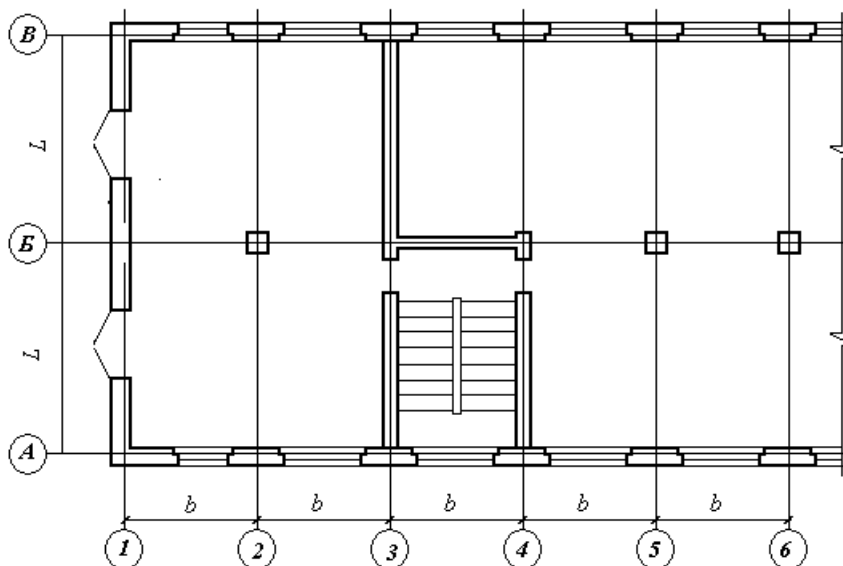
Схема розташування координаційних осей на плані будівлі: b – крок; L – проліт
